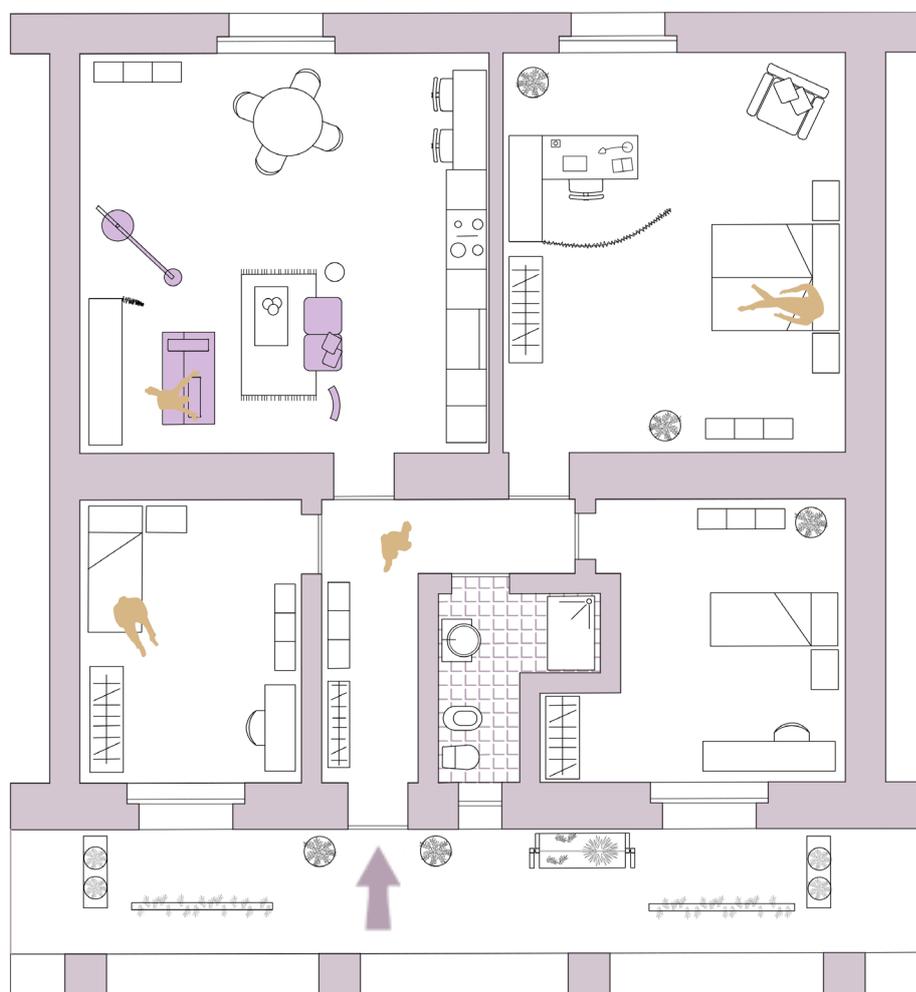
Rappresentazione planimetrica soluzione ambiente fitness / yoga.
